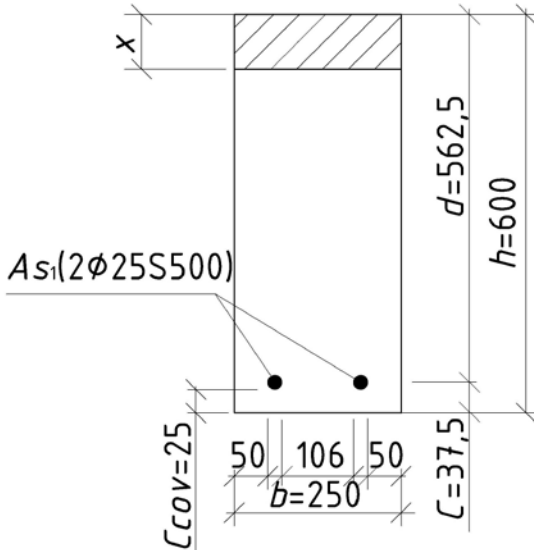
Расчетное сечение балки с оставшейся арматурой
